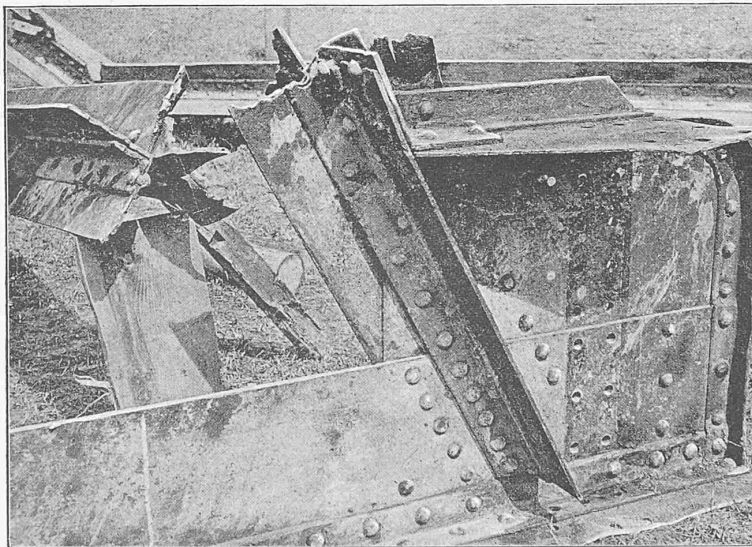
Auflager und untere Gurtung 1 der rechten Tragwand.
